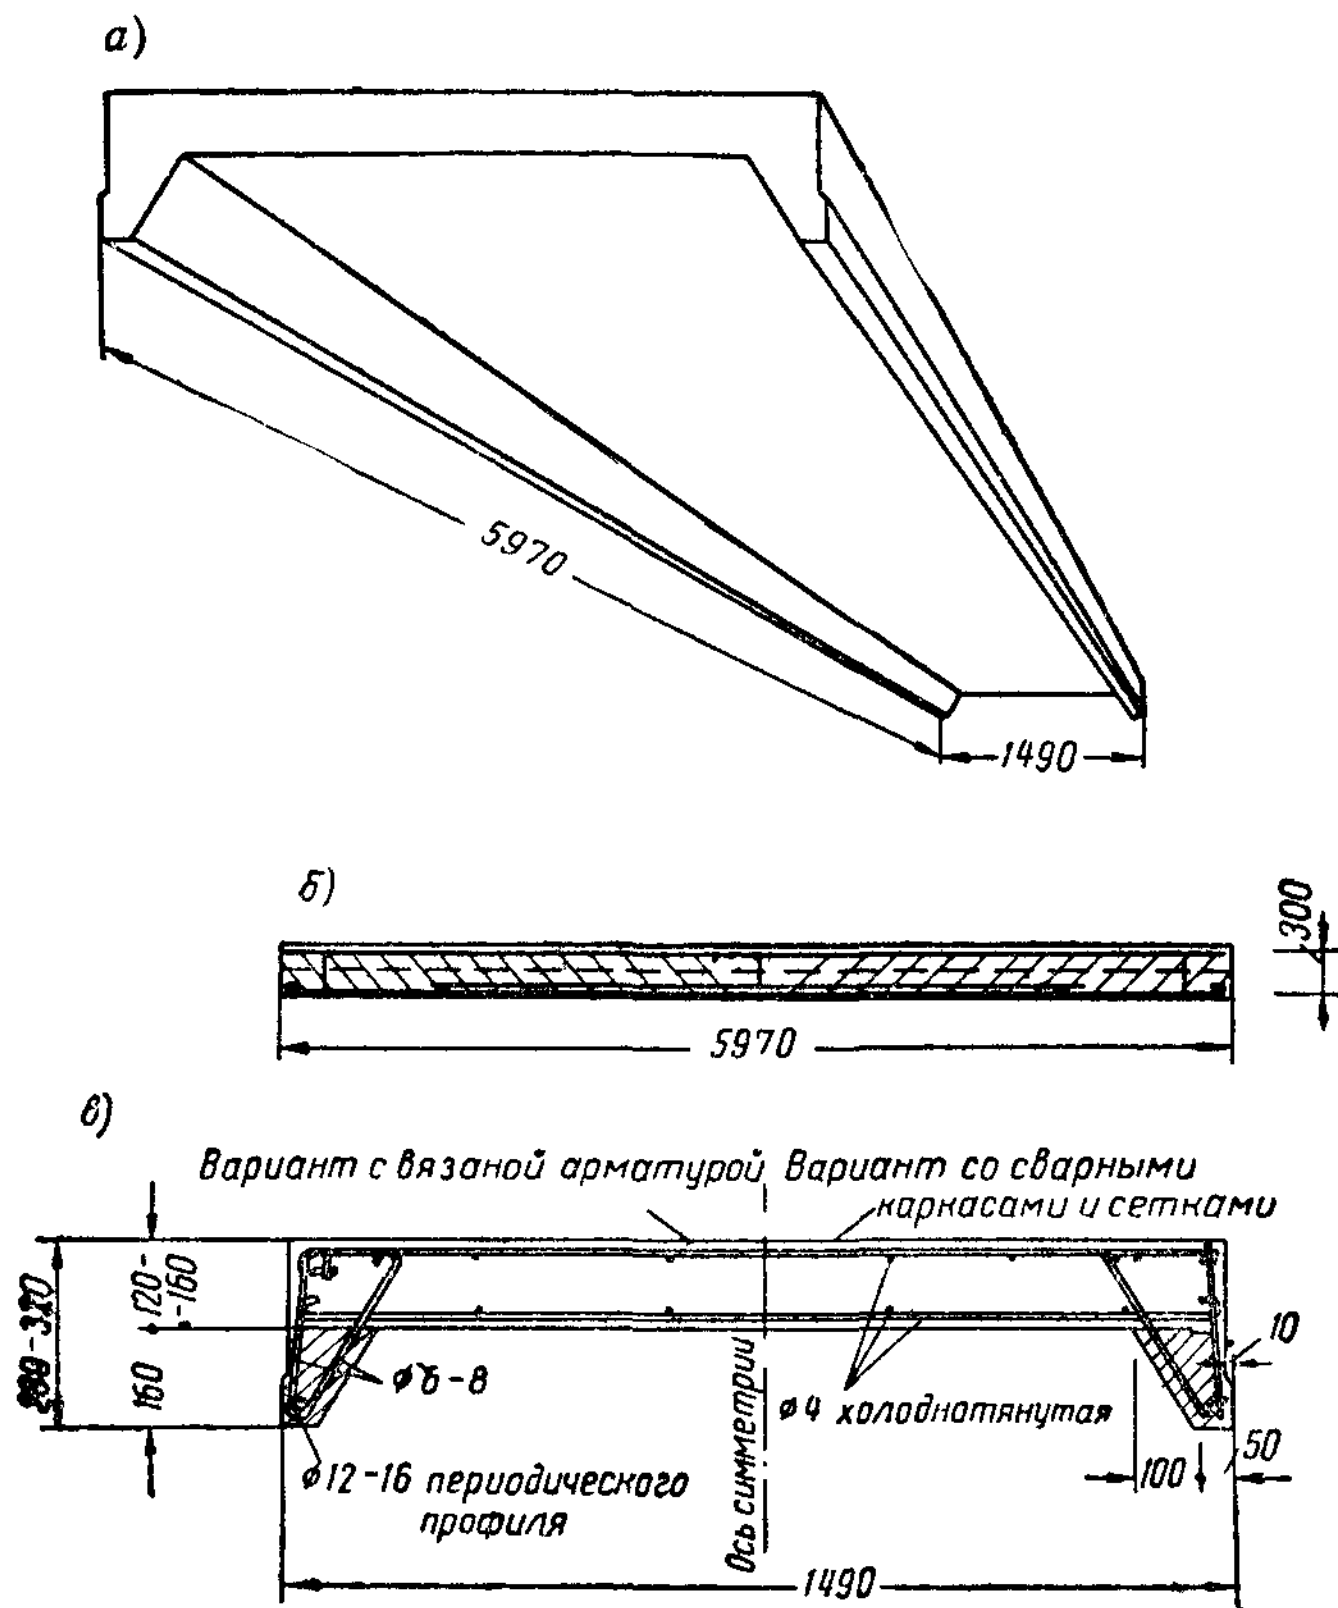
Крупнопанельная армопенобетонная плита
